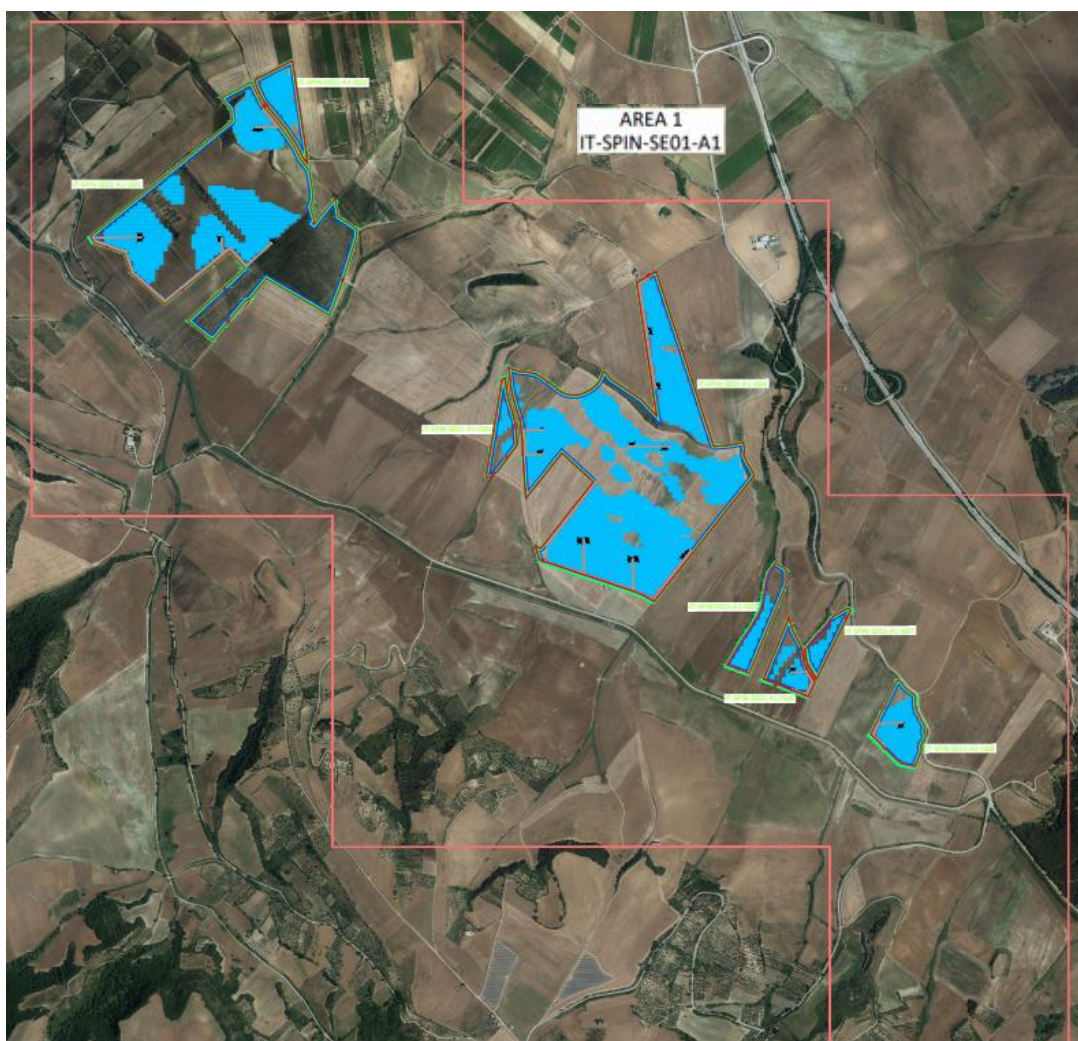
1 - Particolare del layout di impianto su ortofoto – area A1
